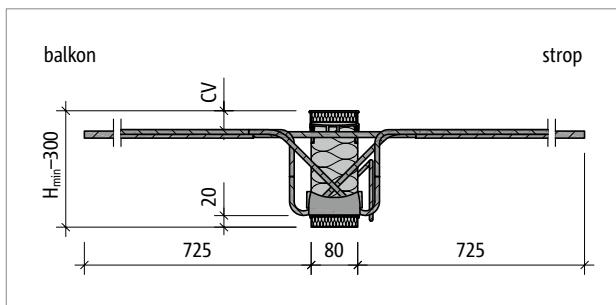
Schöck Isokorb® T tip KL-M10-V2: tloris proizvoda
